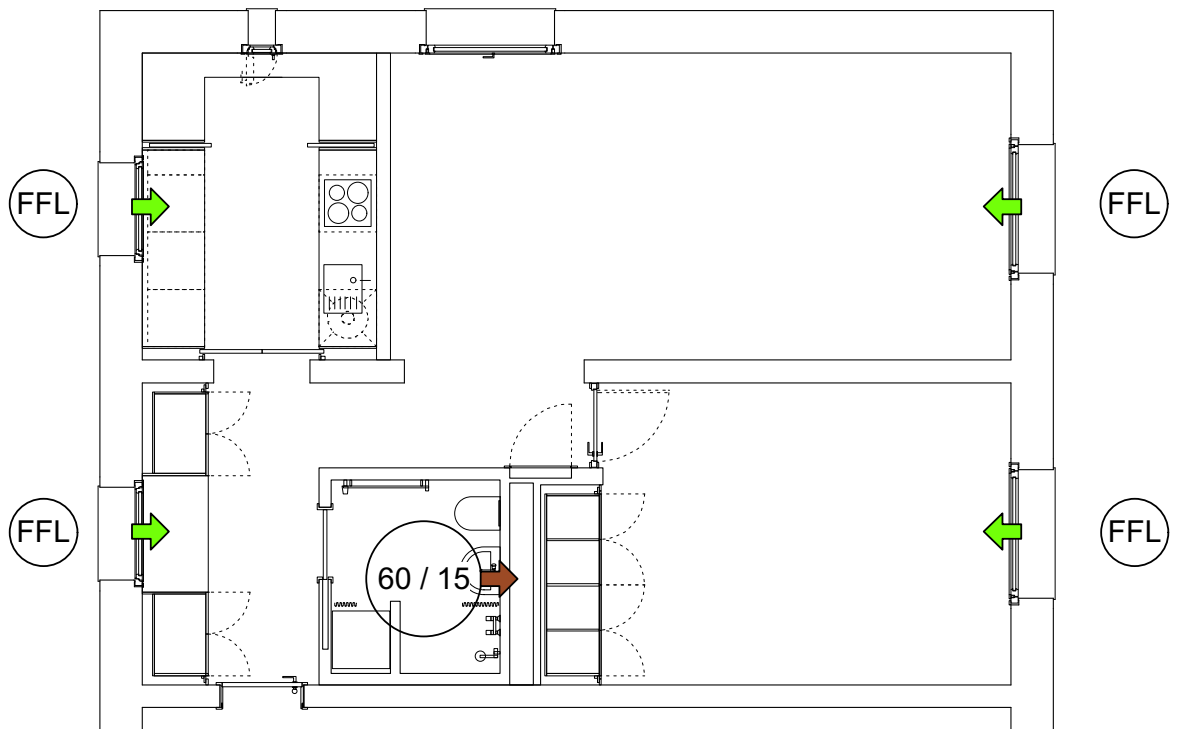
, Grundriss Schema Szenario B: Fensterlüftung / Badabluft präsentgeführt mit Grundlüftung, Quelle: Florian Nagler Architekten / Tilmann Jarmer, TU München [Jarmer 2023]
